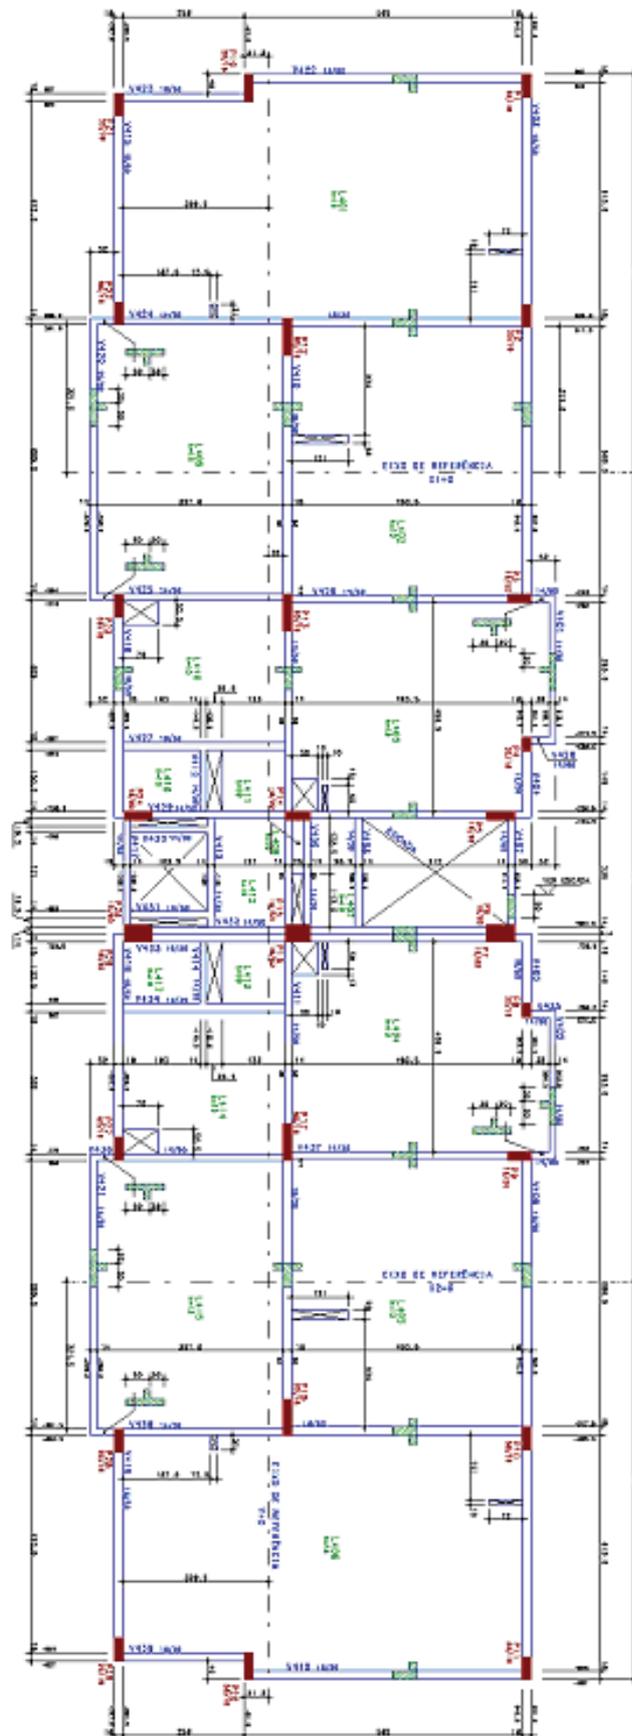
planta de fôrmas completa do pavimento tipo em laje convencional
